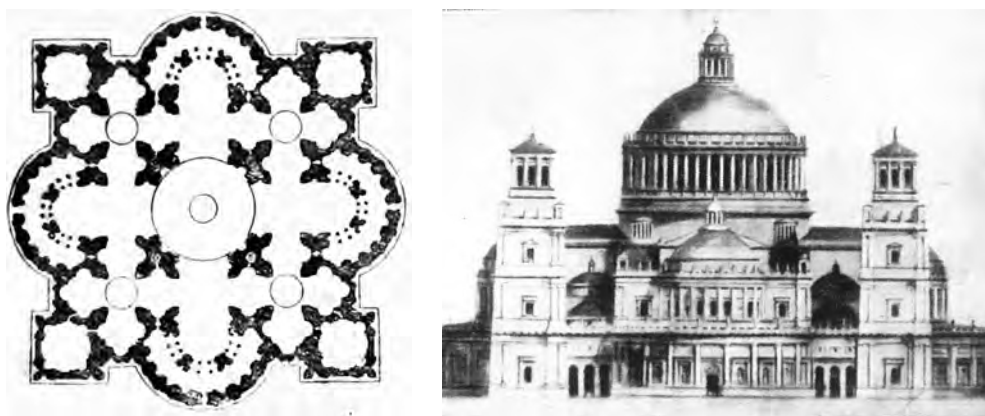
Проект собора св. Петра (арх. Д.Браманте): а – план; б – фасад
